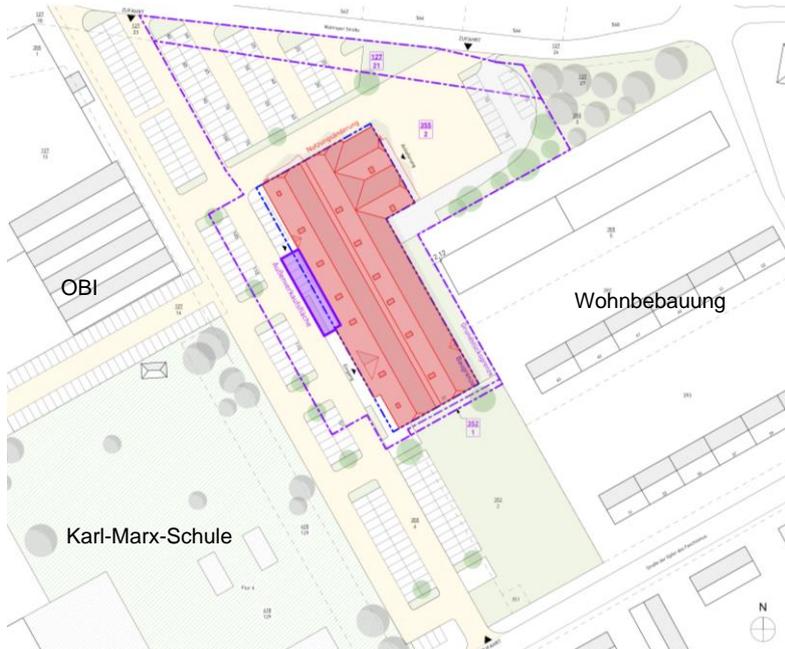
Lageplan (Morese Architekten, Stand 08/22)
